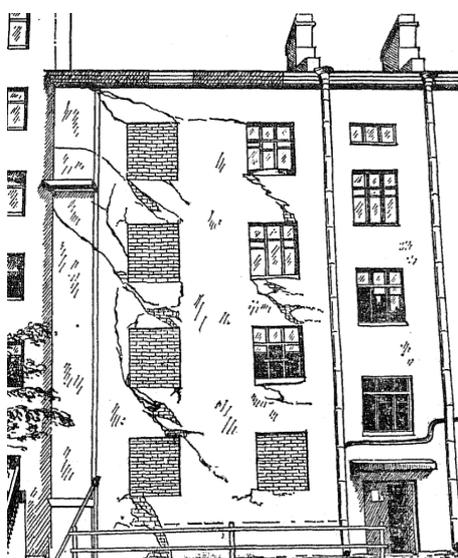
Повреждение кладки стен 4-этажного здания на ленточном фундаменте после возведения около него 11-этажного дома
